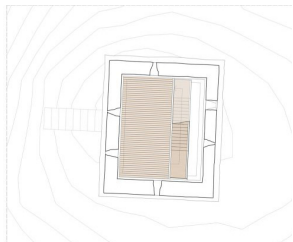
Detalles constructivos intervención. El fabricante de esferas.
